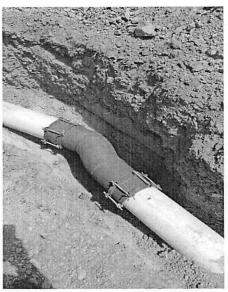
Codo de Acero con Junta Dresser en Tubería de Ø12" PVC SDR-26
